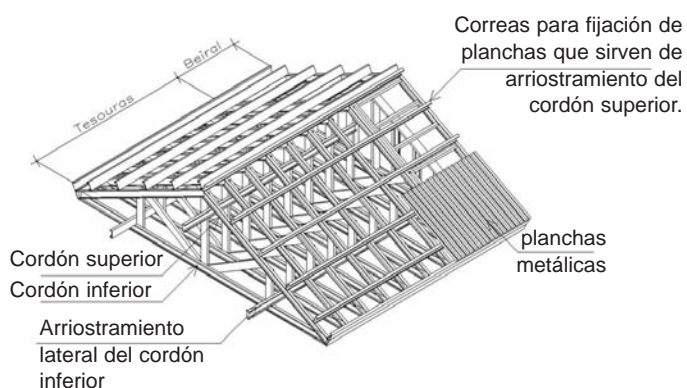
Tejado estructurado con cubierta de planchas de acero.
